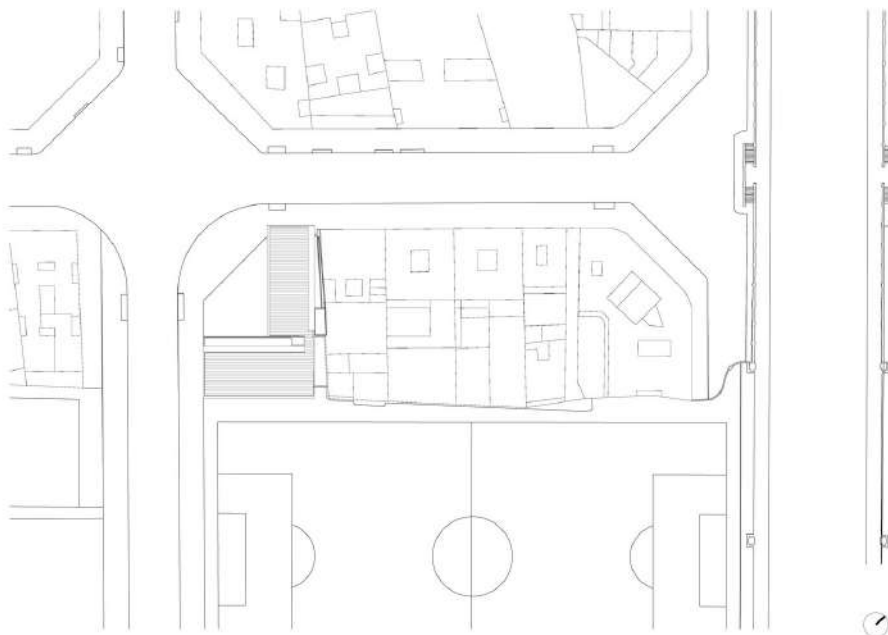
Planta de sitio proyecto 51 Viviendas sociales públicas. Fuente
